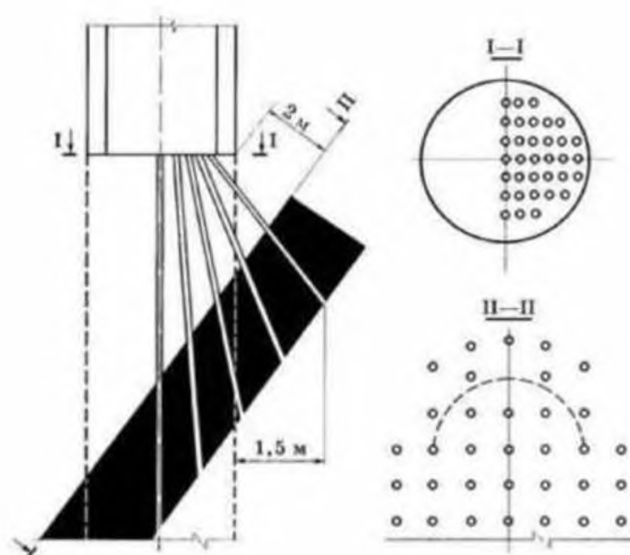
Схема расположения дренажных скважин при вскрытии угольных пластов крутого залегания
